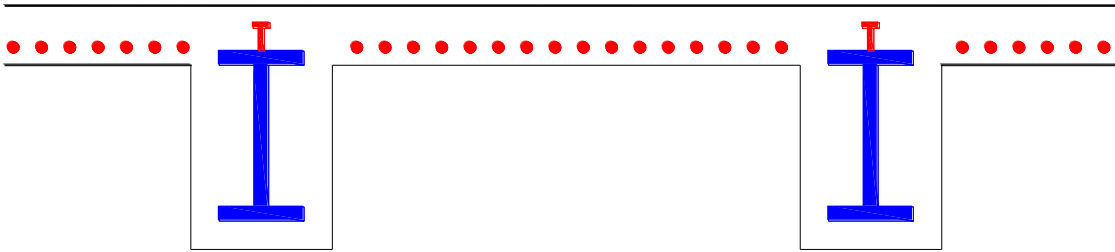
Viga de acero ahogada en concreto. La losa se encuentra unida a la viga mediante conectores de cortante
